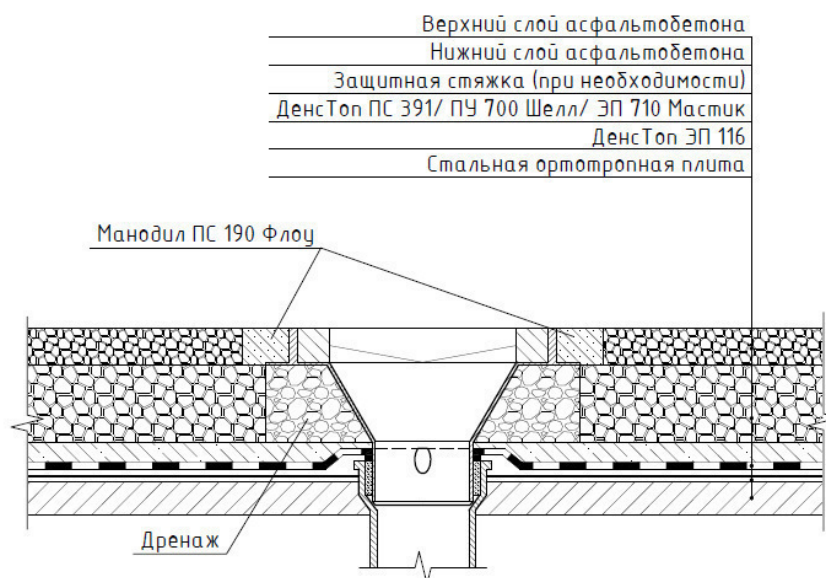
Сопряжение гидроизоляции с водоотводной трубкой
